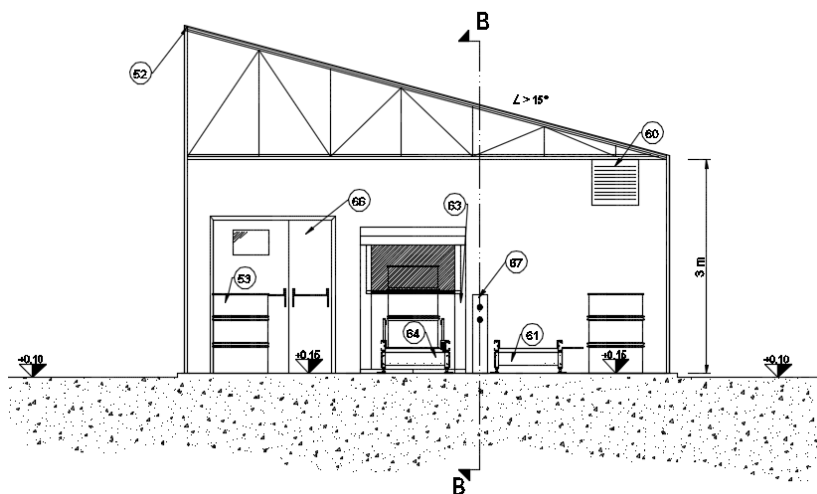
Sezione in corrispondenza dell'area di maturazione dei manufatti
